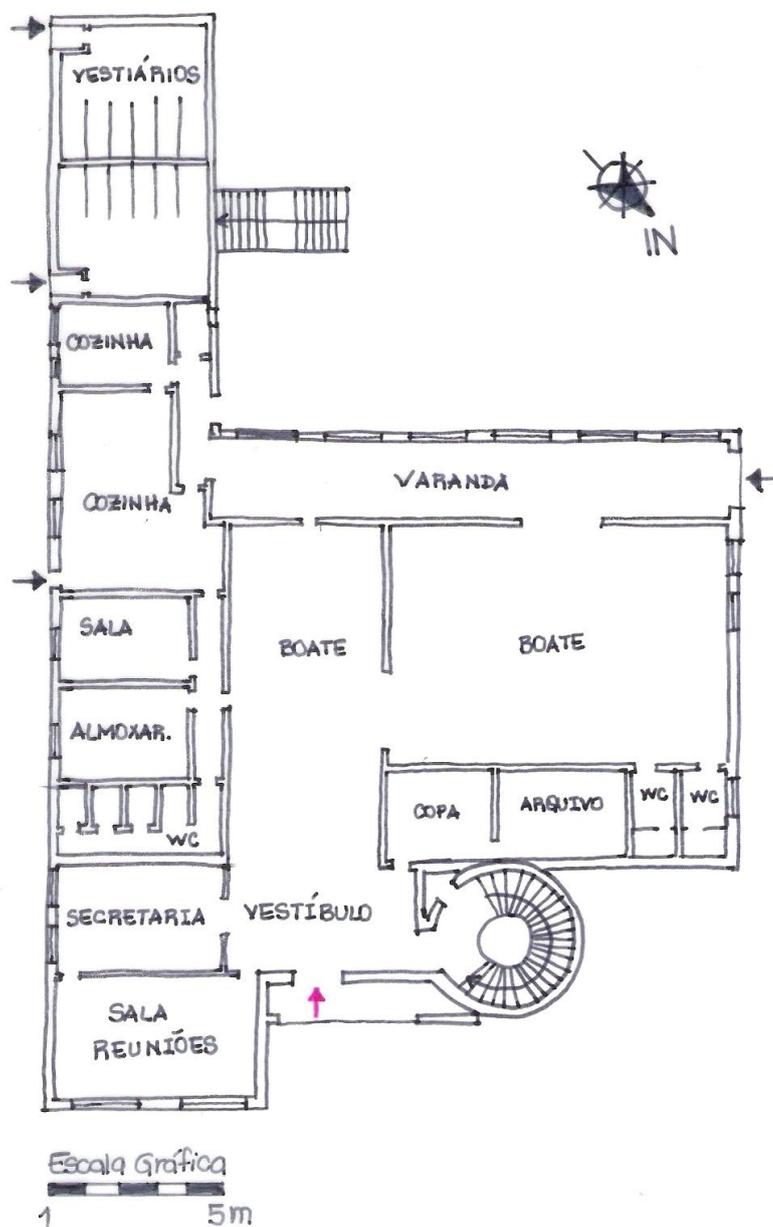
Planta Baixa esquemática – Pavimento térreo, imagem mostrando a composição da forma da edificação.
